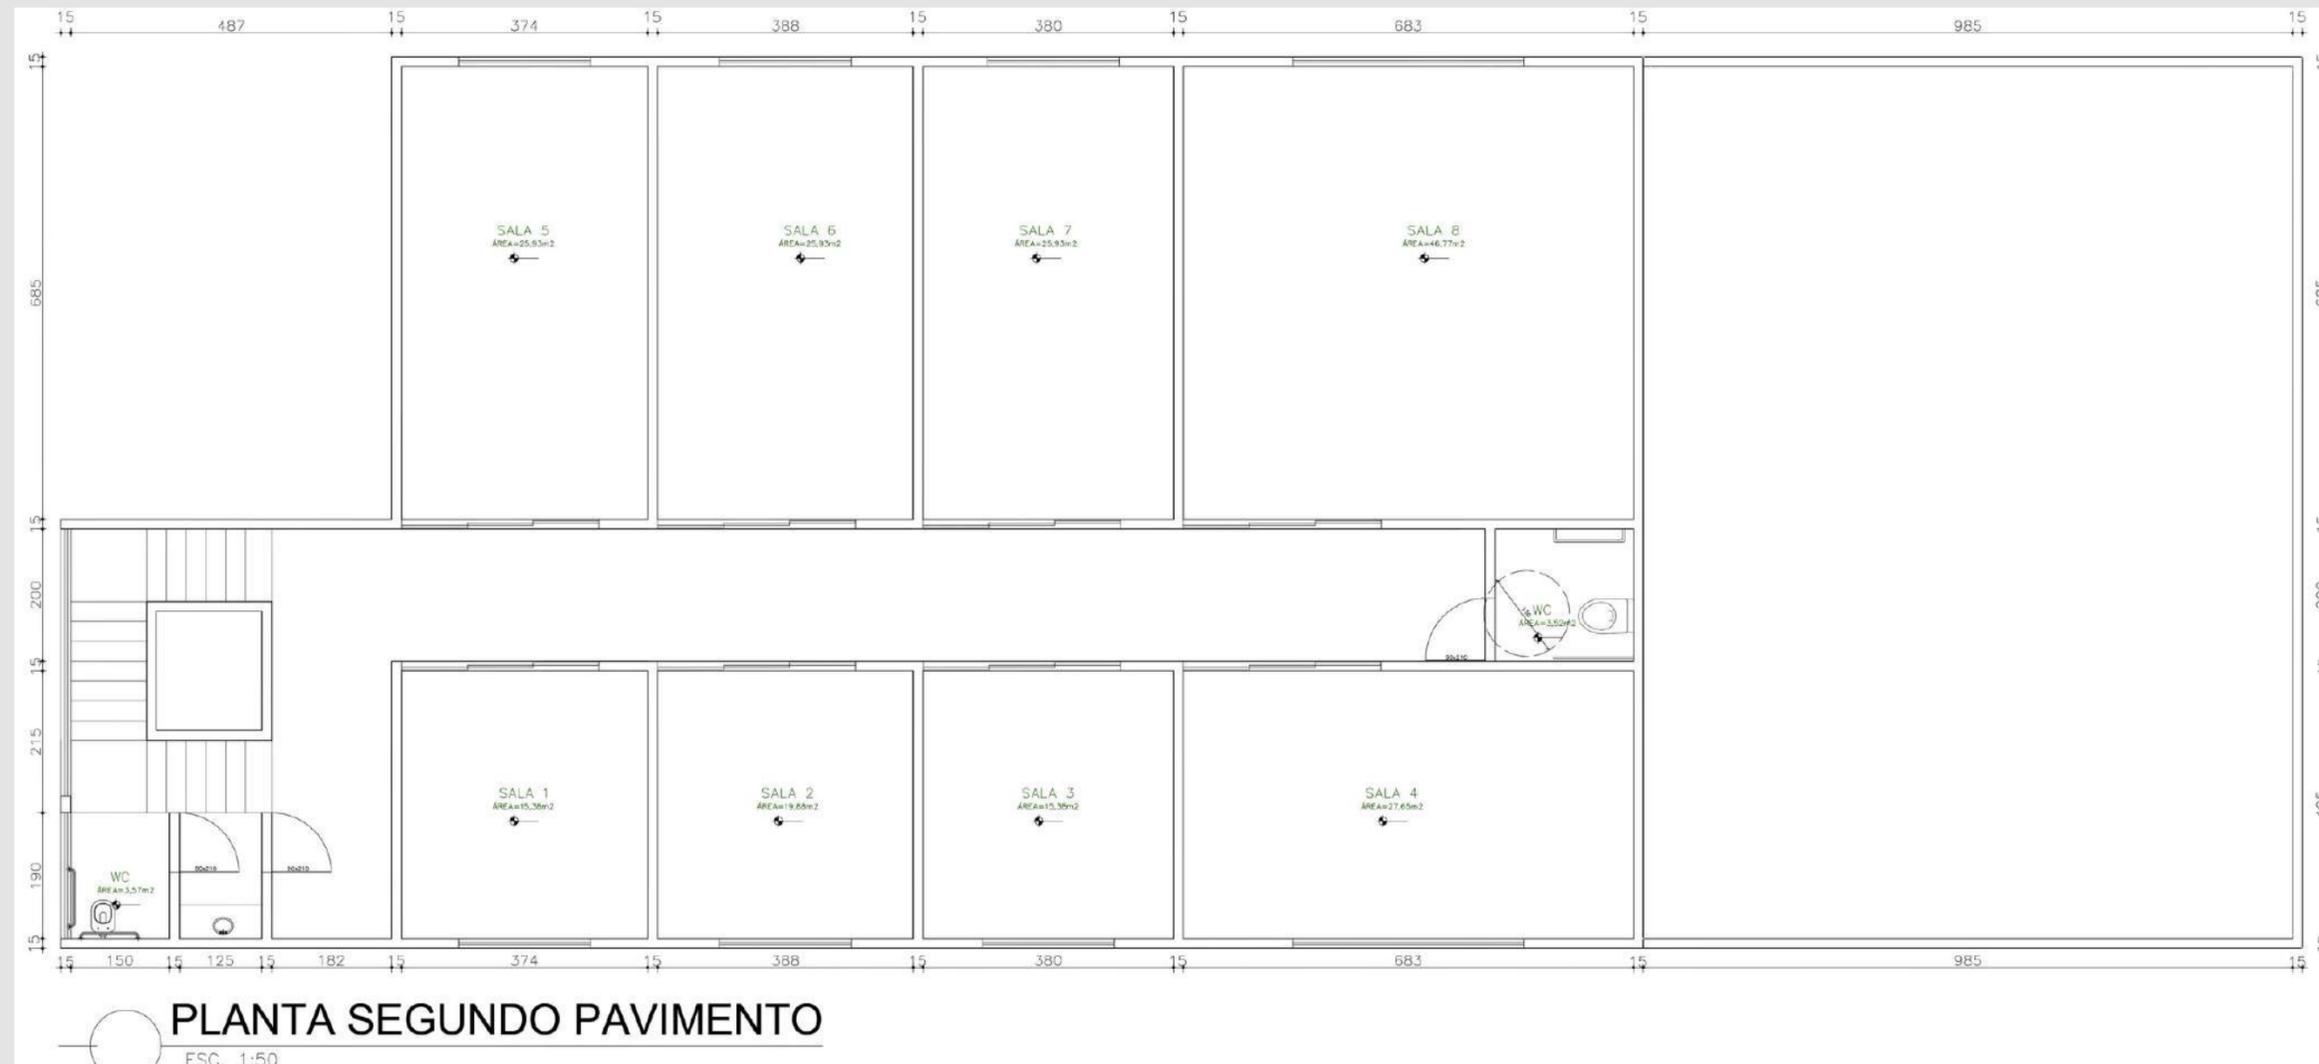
PLANTA ORIGINAL DO PROJETO
